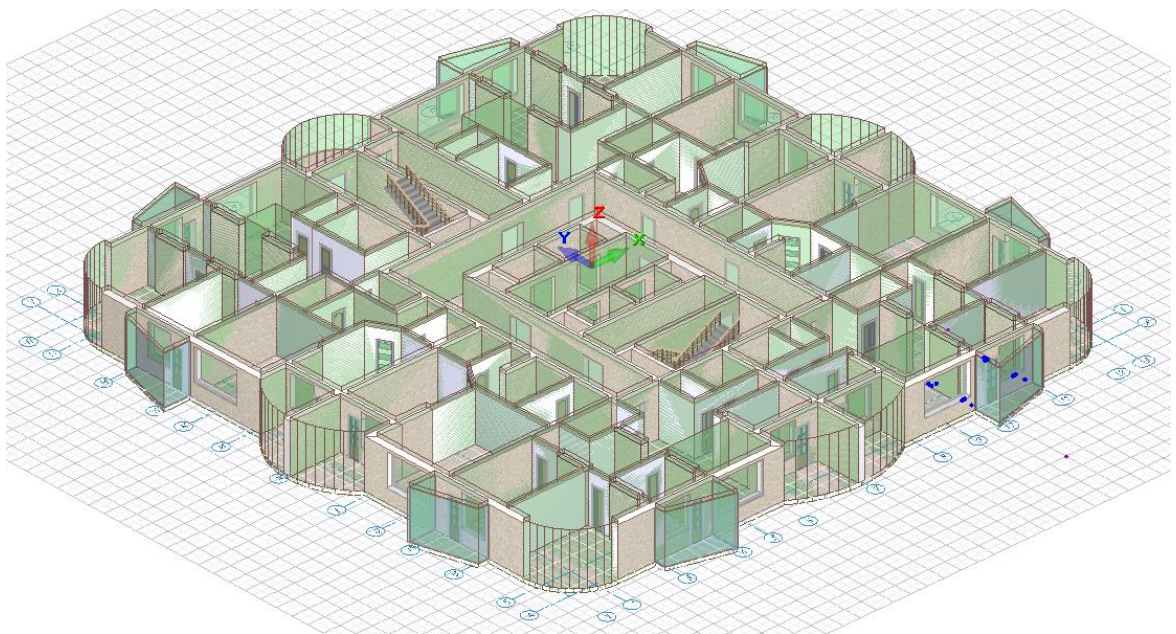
Расположение помещений типового этажа высотного здания
